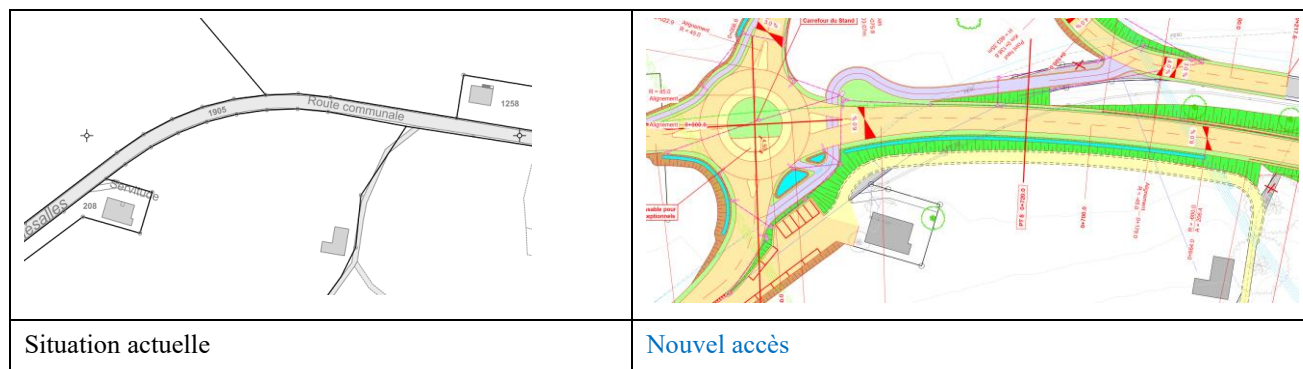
Adaptation du raccord de la route secondaire à la route cantonale
